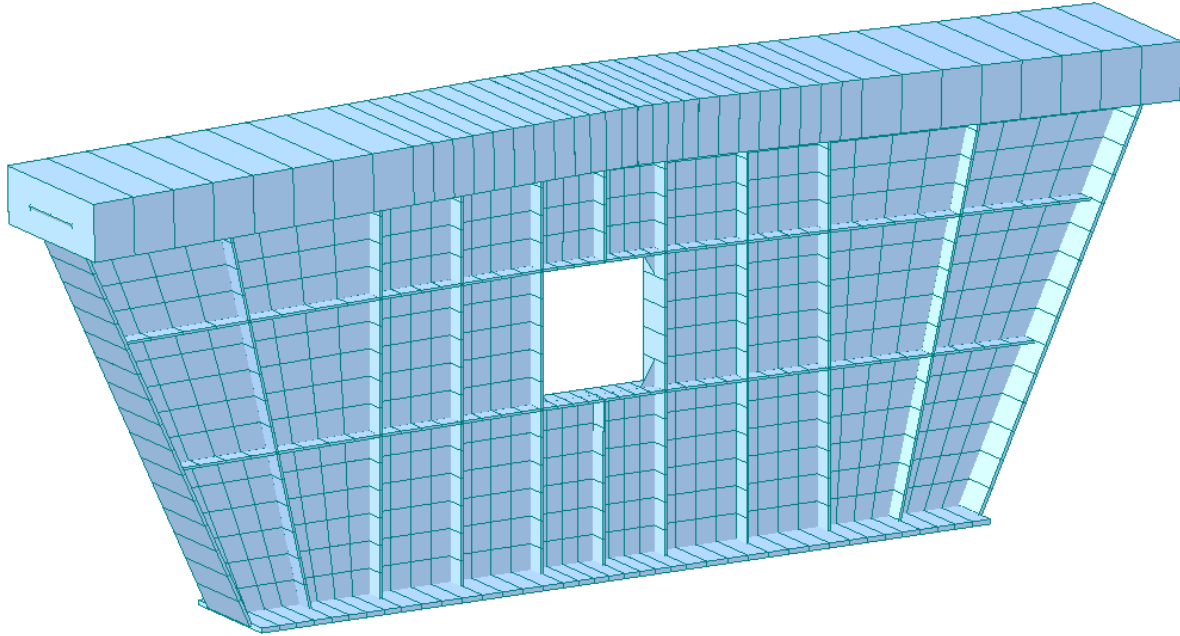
SCHEMATIZZAZIONE DELLA STRUTTURA – MODELLO ESTRUSO
